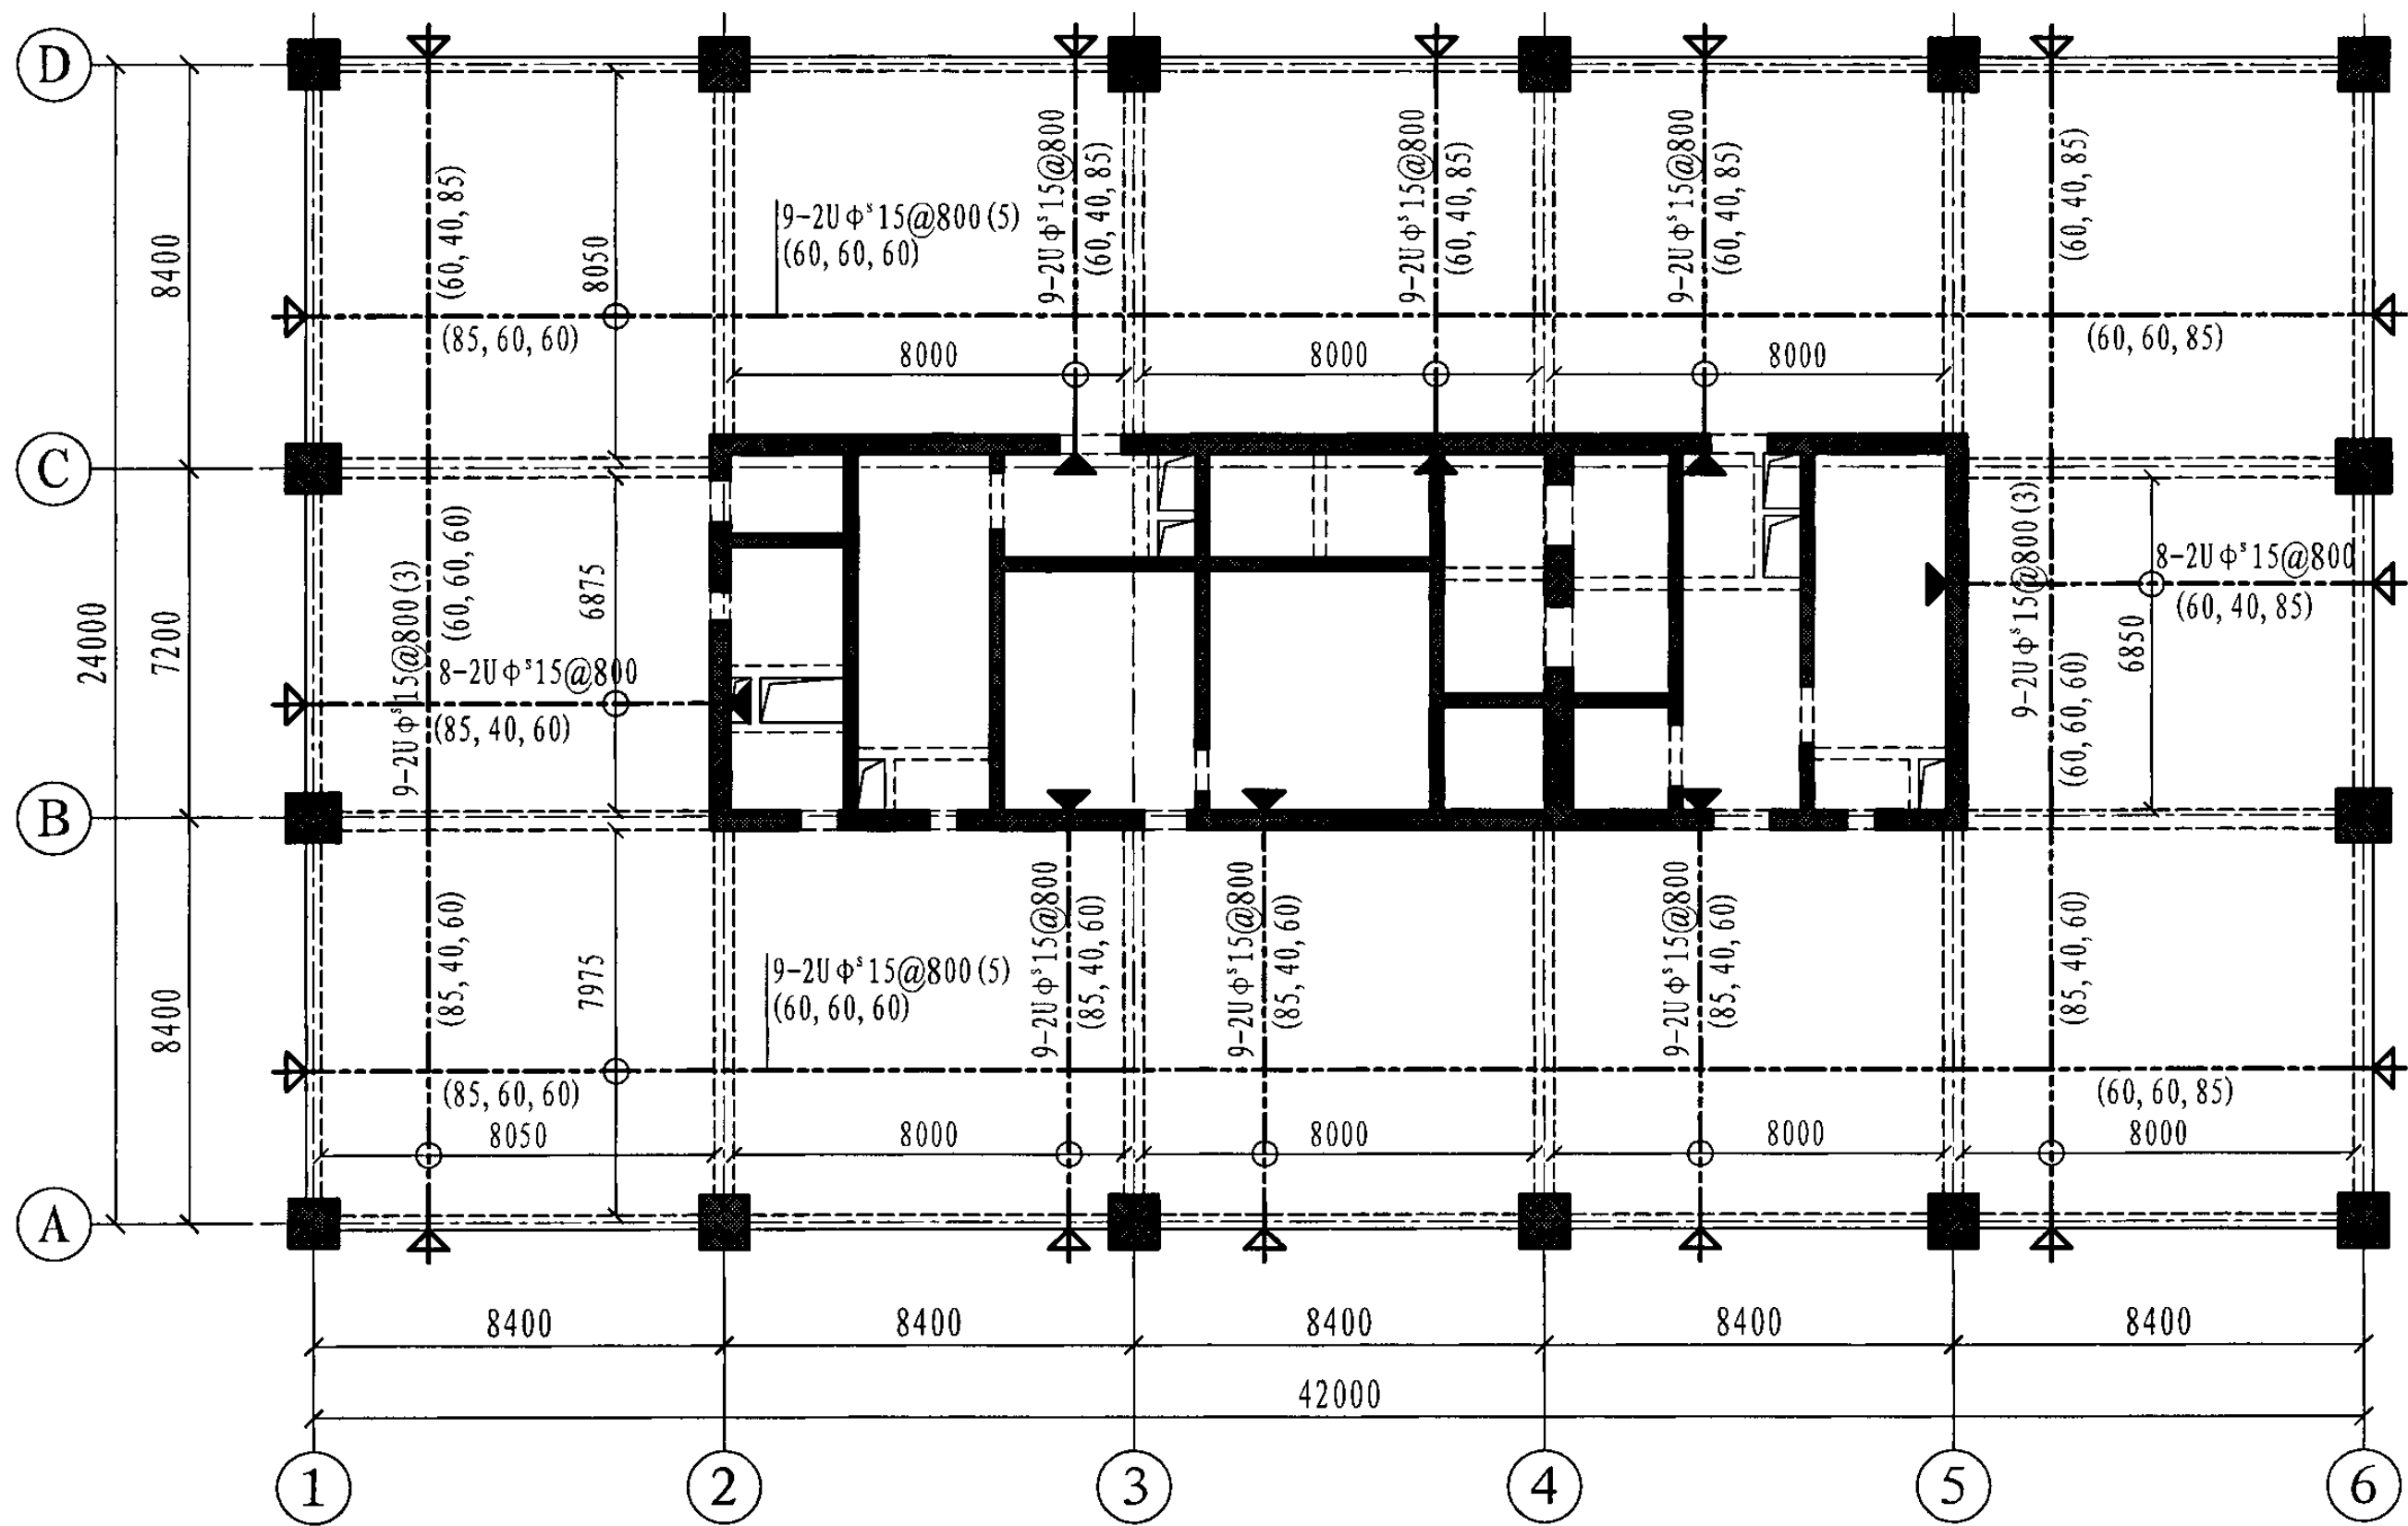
周边支承预应力板施工图平面表示方法示例
